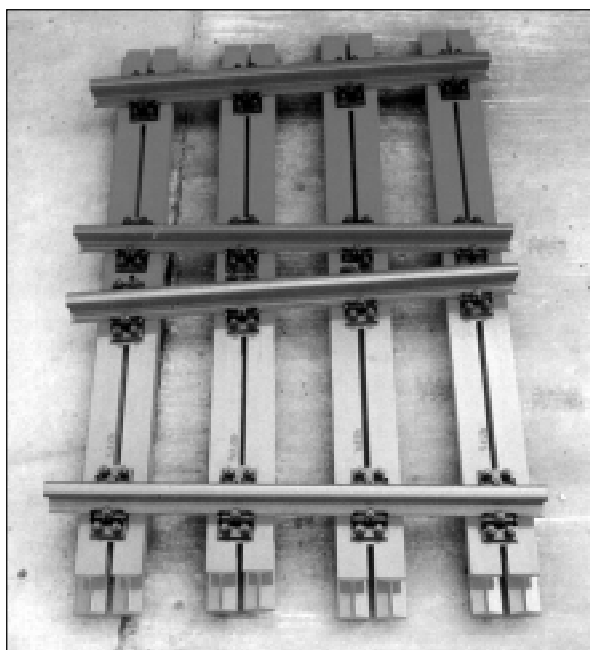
Fragment rozjazdu z podkładami stalowymi typu YH [3]
